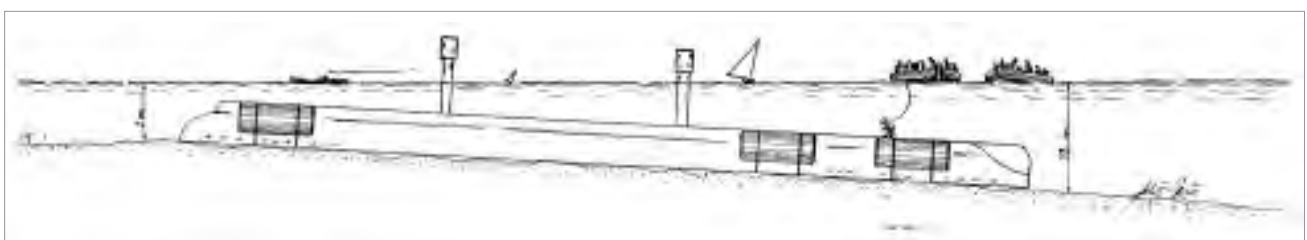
Disposizione dei cilindri stabilizzatori.
